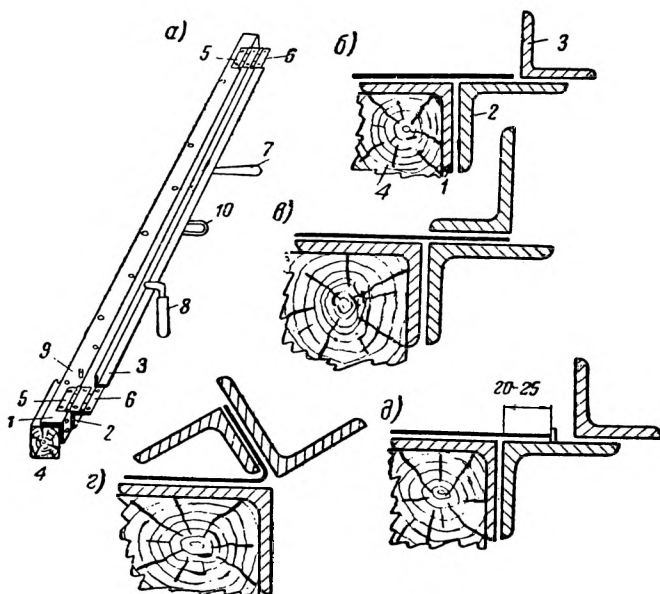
Станок № 1 конструкции А. И. Демина для заготовки стоячих фальцев:
